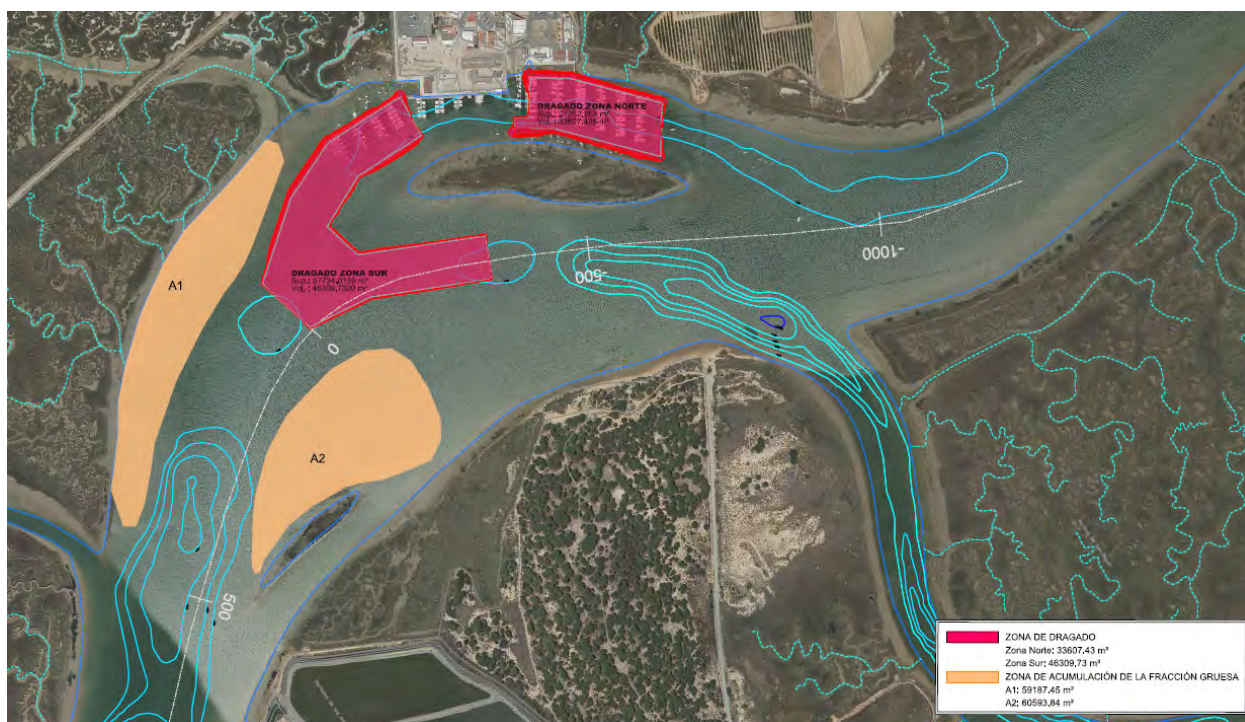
Planta de la propuesta de dragado en el puerto de El Terrón.
